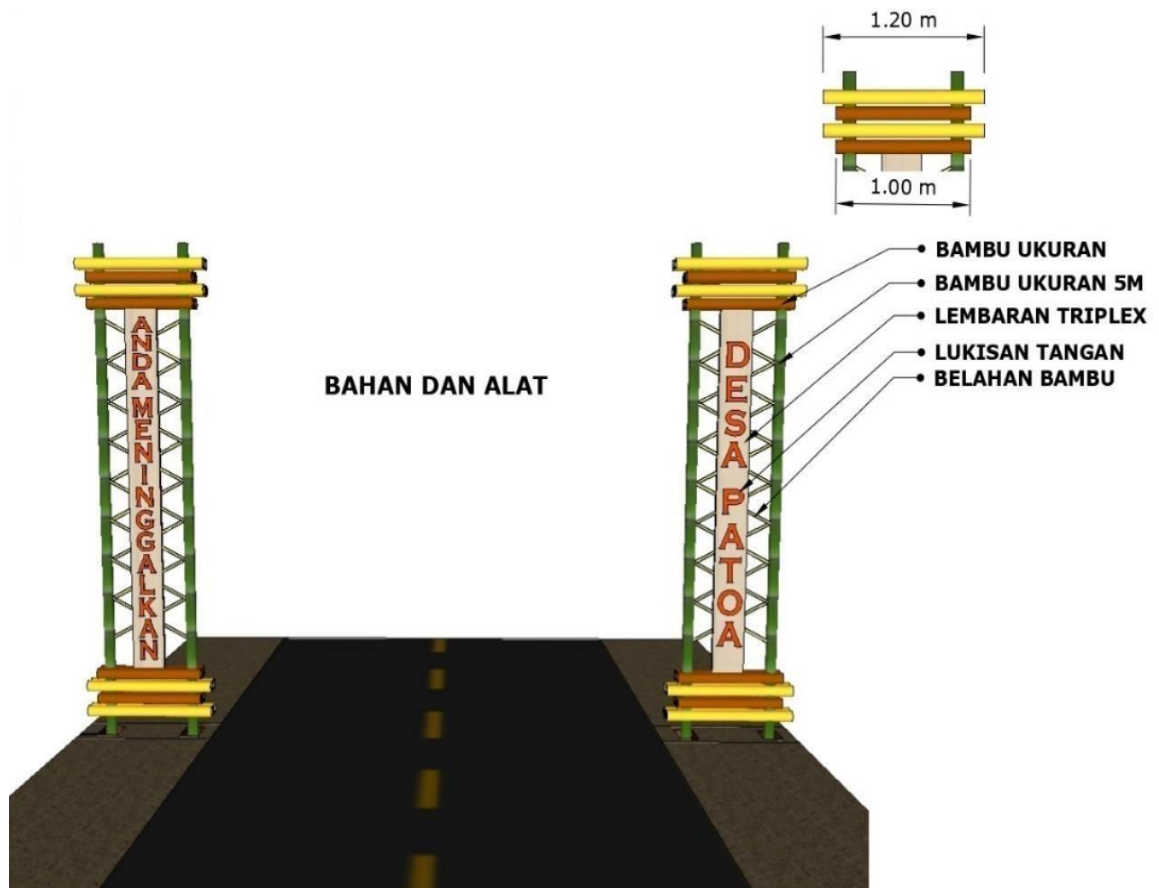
Detail Palang Bambu Gapura Desa Patoa
